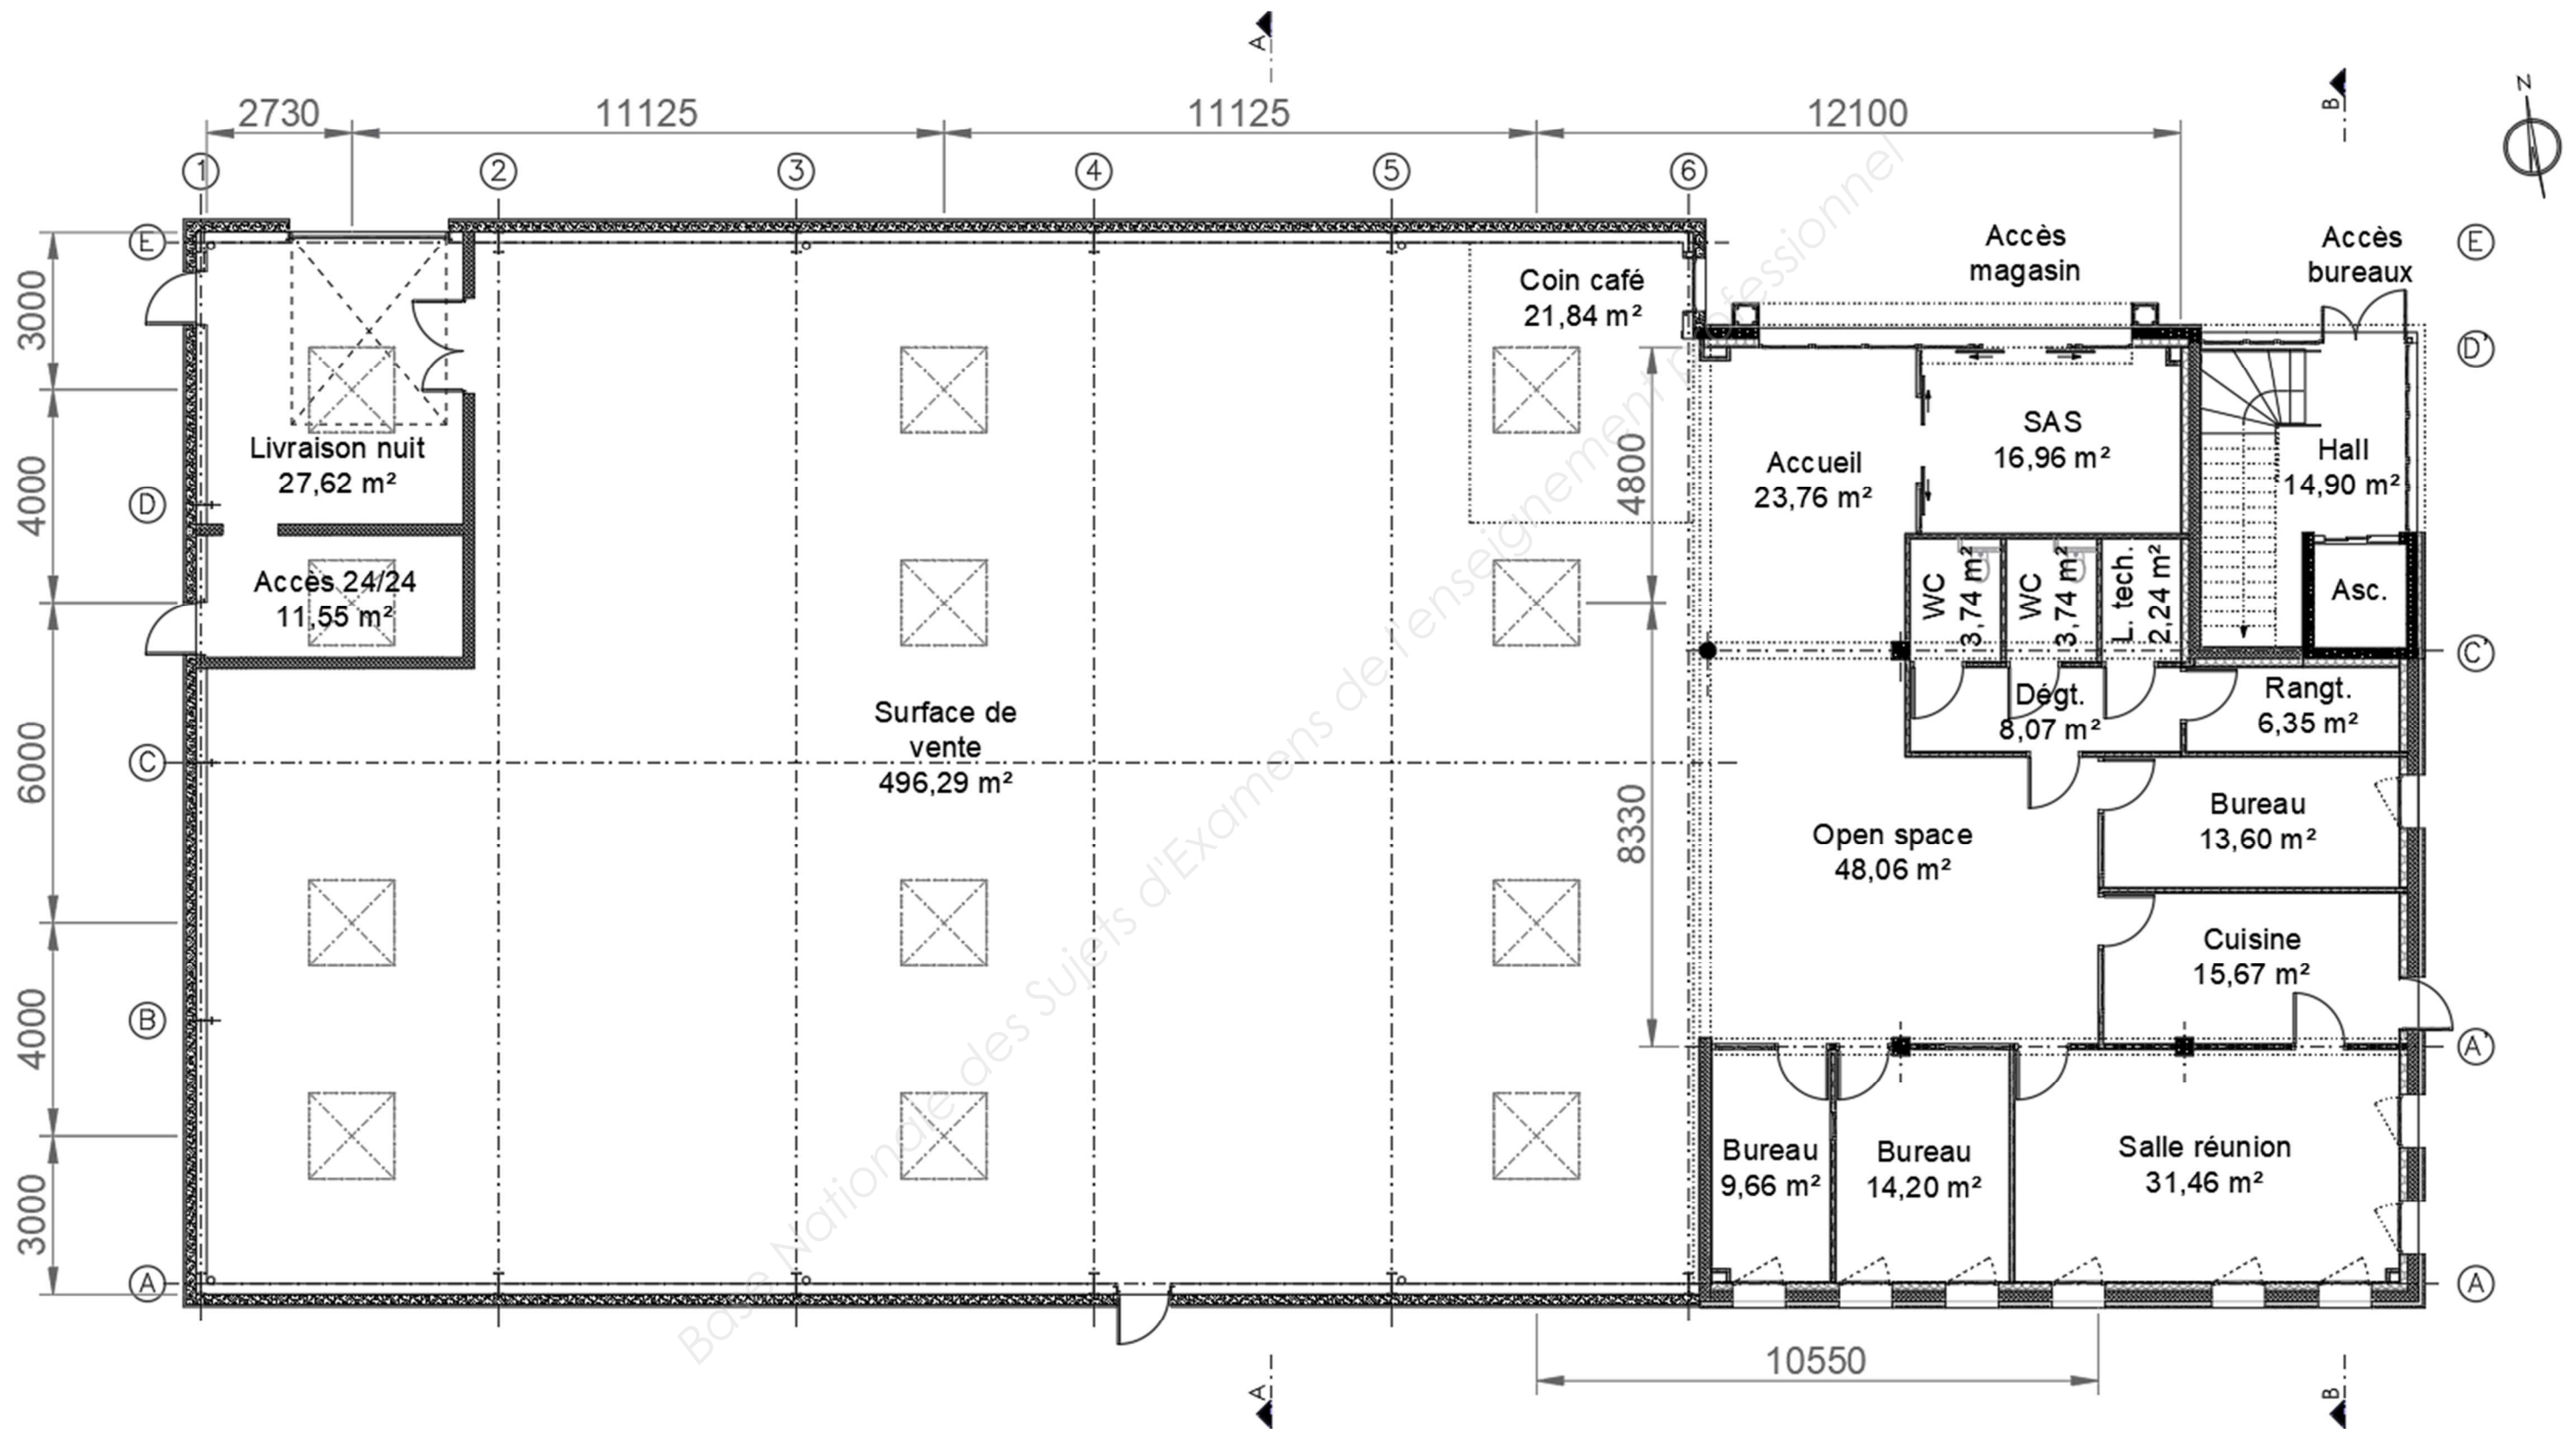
Rez-de-chaussée (avec positionnement des lanterneaux)
